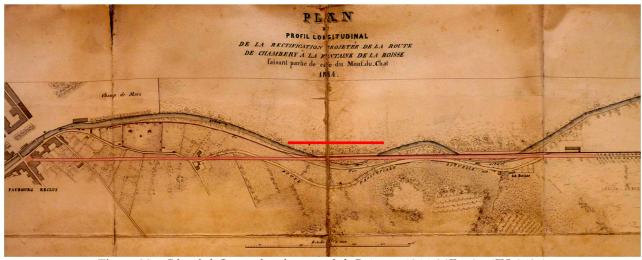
Plan de la Leysse dans le secteur de la Boisse en 1844 (AD 73 - 1FS 3587)
